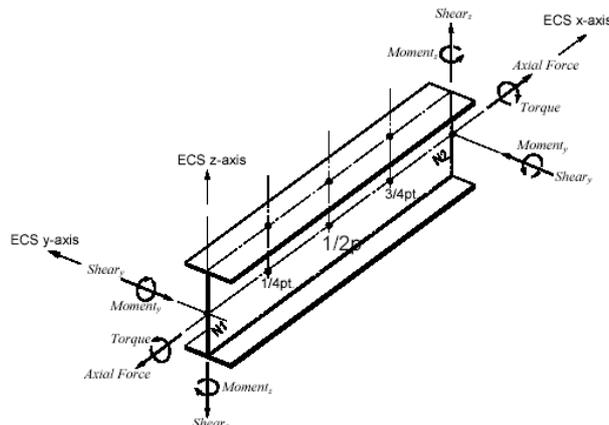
Rappresentazione verso componenti di sollecitazione interna
